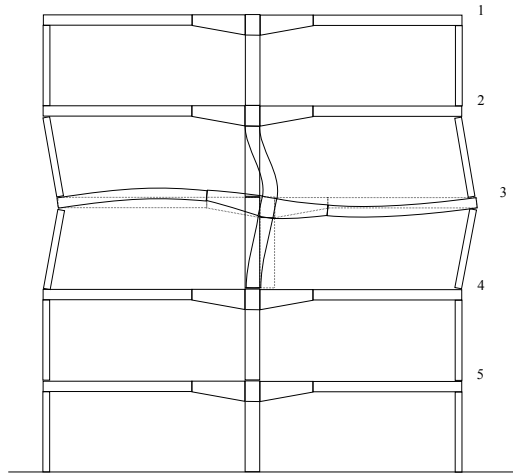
Pórtico de cinco plantas: movimientos de planta
